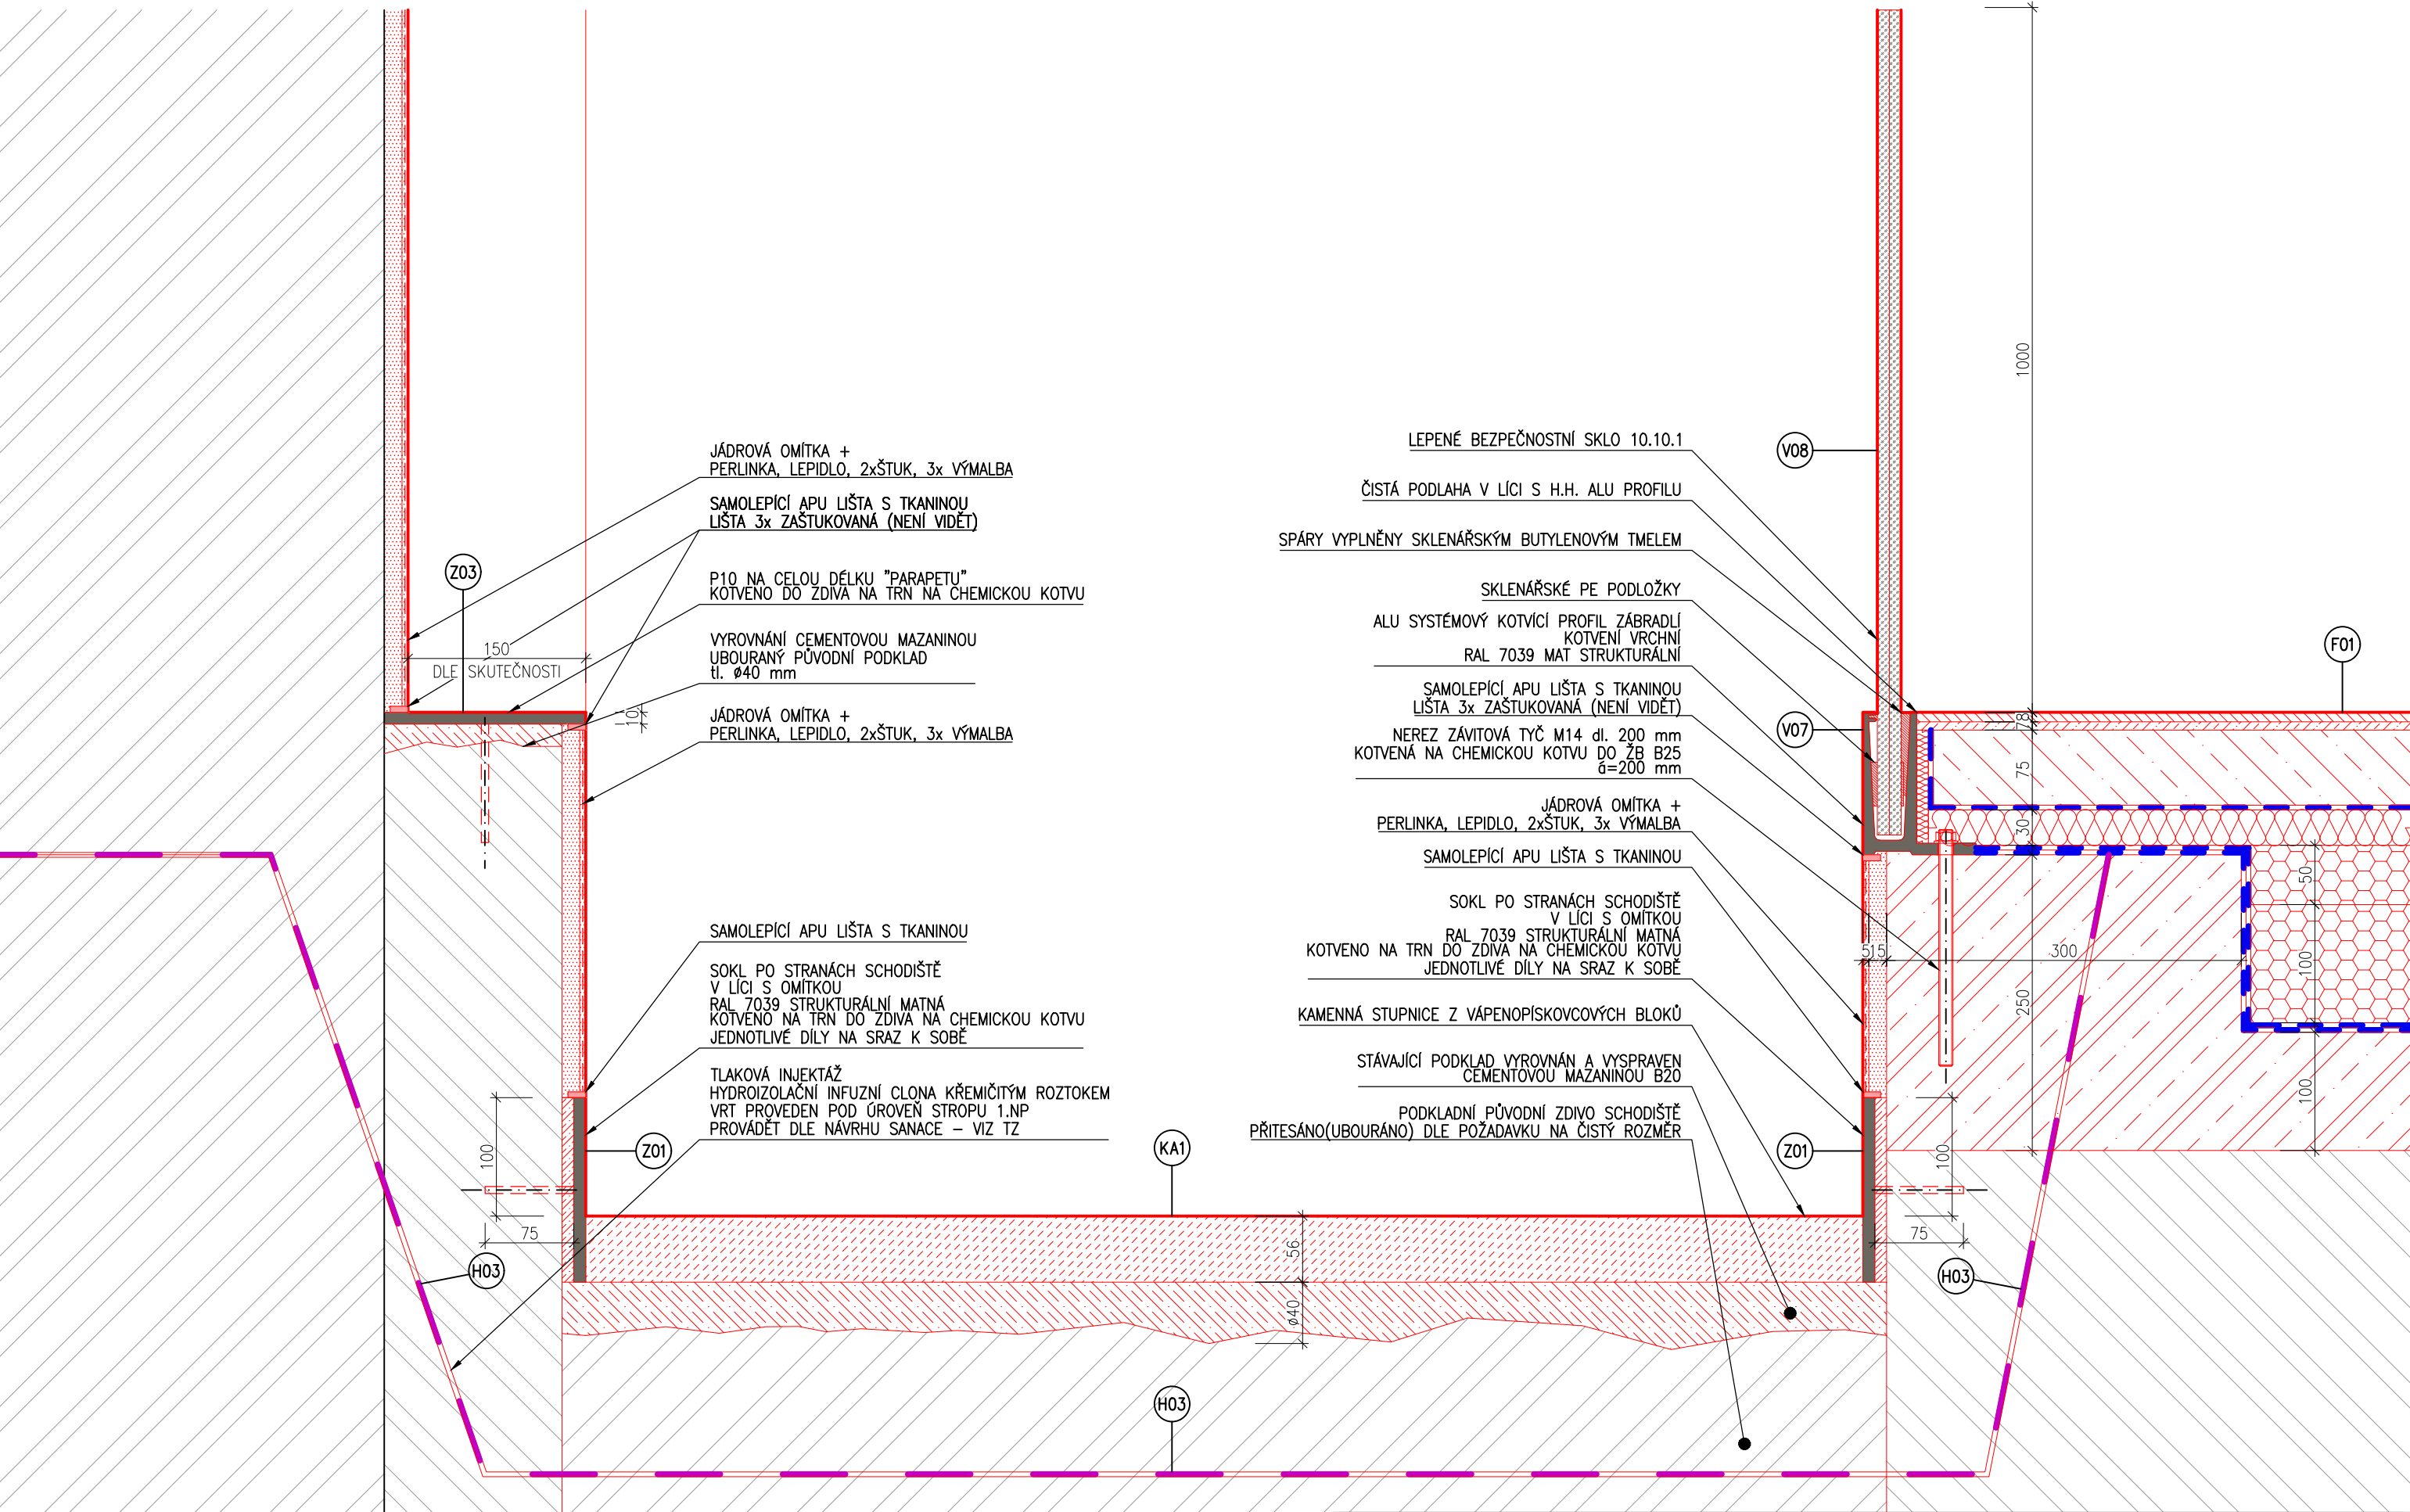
DETAIL DOPLNĚNÍ SCHODIŠTĚ NA PAVLAČ
